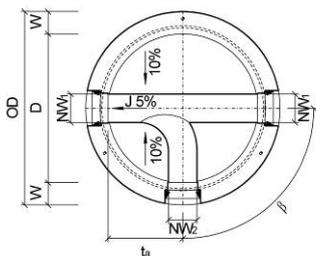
Grundriss CRENO Normschachtboden Typ 7
